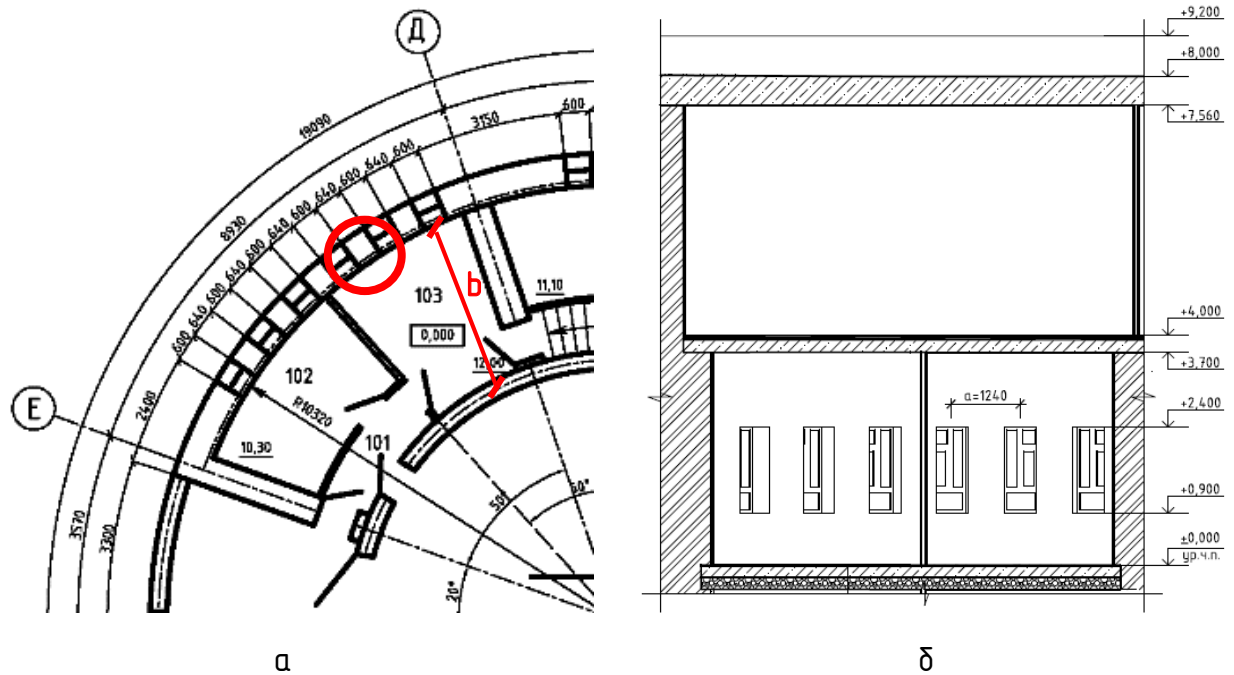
Схемы к расчету несущей способности простенка: а – Фрагмент плана 1 этажа, б – Фрагмент разреза наружной стены
